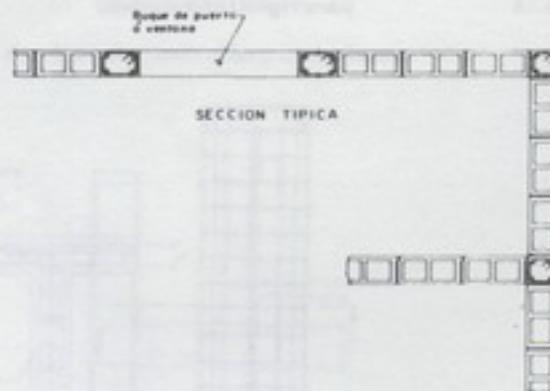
Corte típico, corte en puerta y corte en ventana en concreto reforzado.
